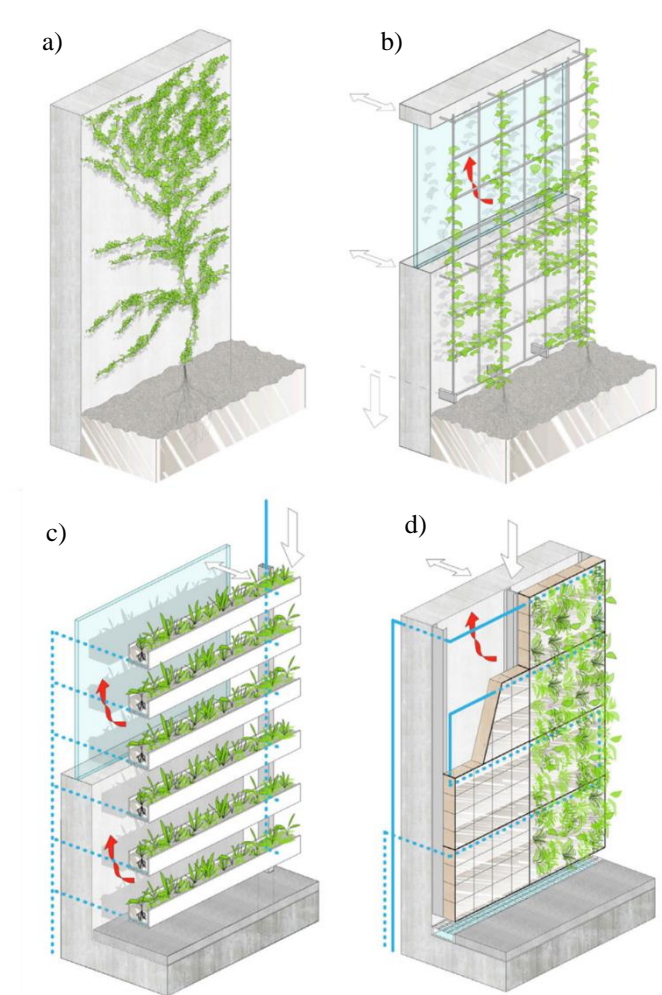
Ausbildungsformen der Fassadenbegrünung a) mit Selbstklimmer b) mit Gerüstkletterpflanzen c) wandgebundenes lineares System d) wandgebundenes modulares System. Types of facade greening a) climbing plant without frame b) climbing plants with frame c) in-line living wall d) modular living wall. Quelle: Nicole Pfoser 05/2013 [3]
